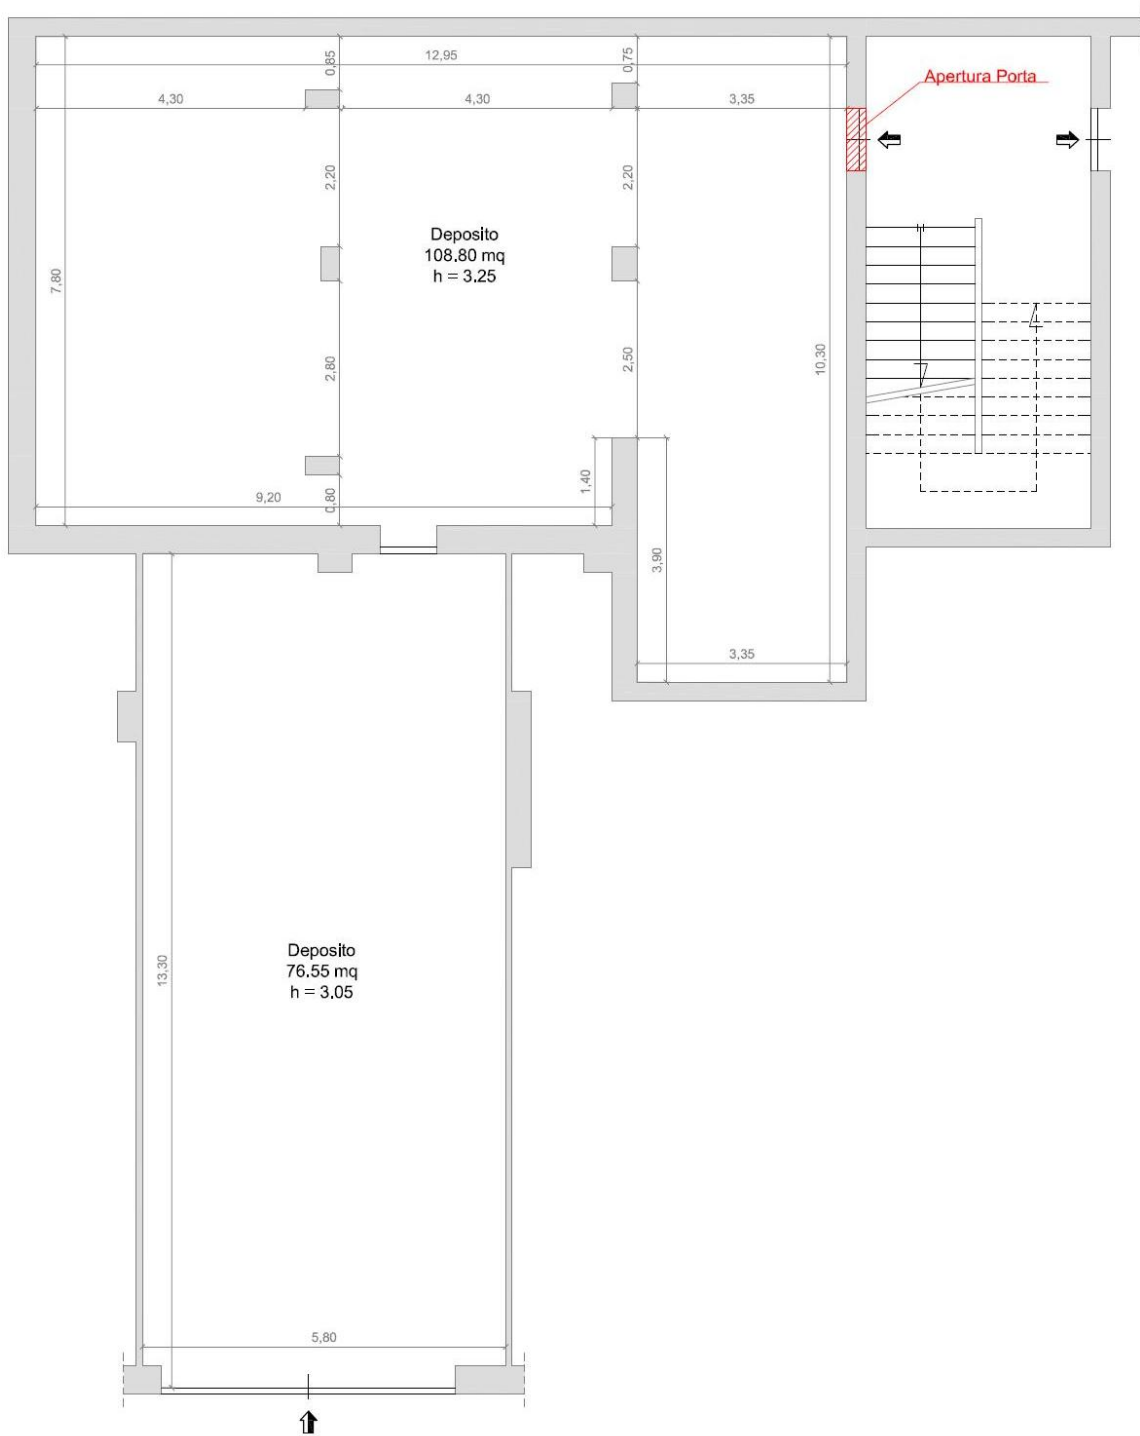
Planimetria Stato di fatto Foglio 46, p.lla 1235, sub 14.
